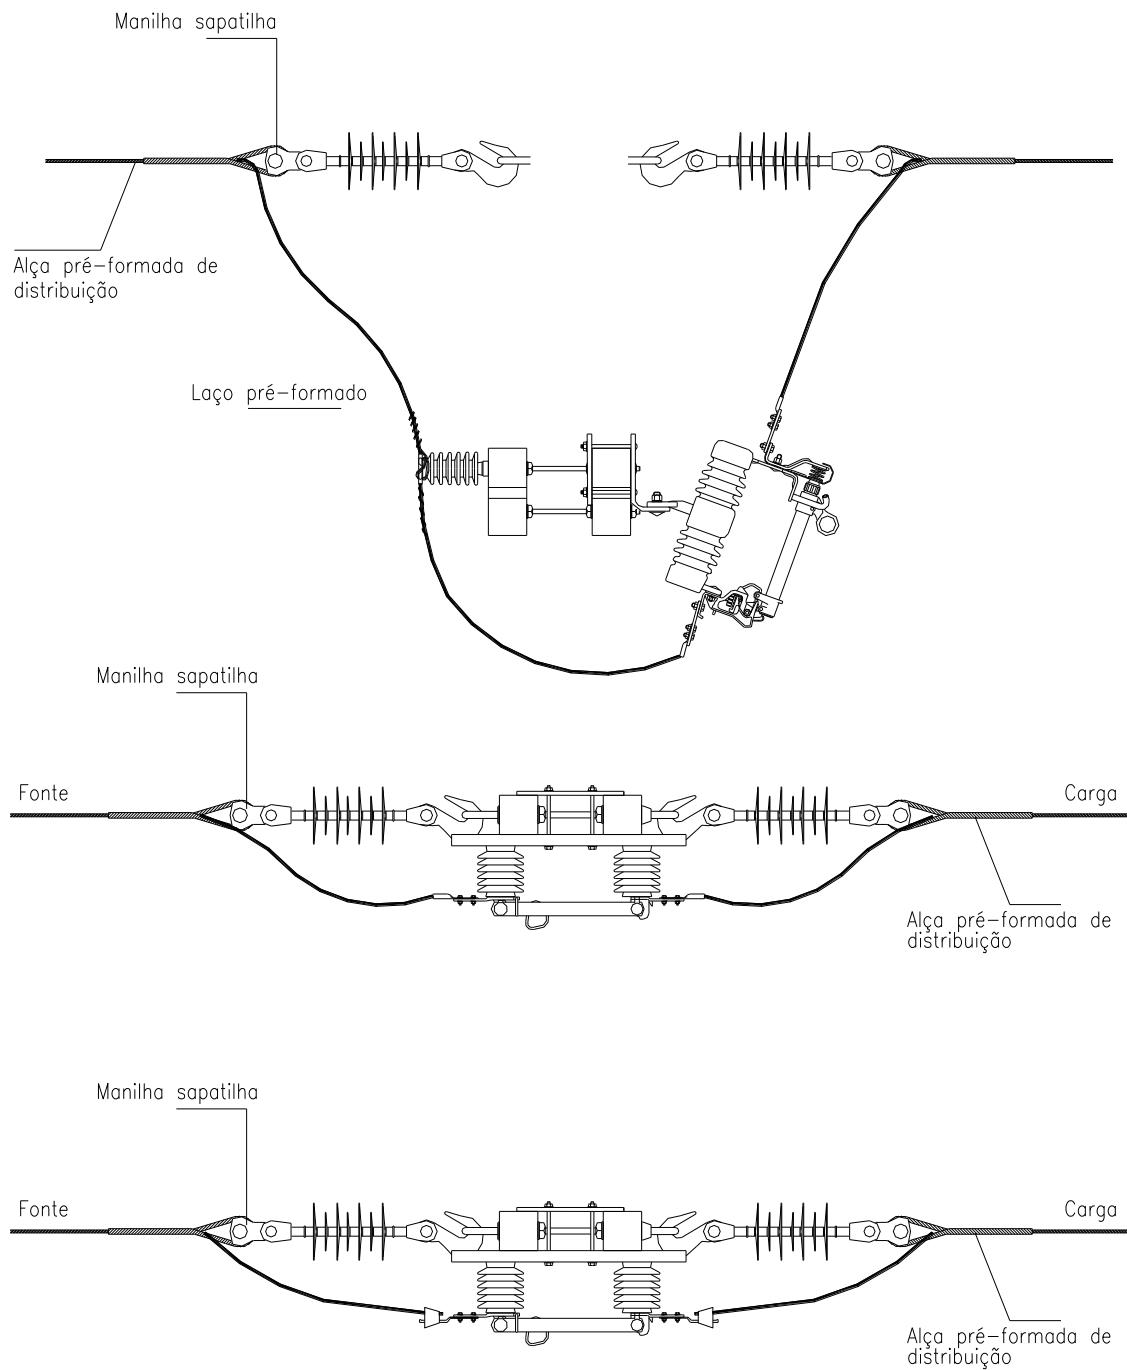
Amarrações e ligações – Primário – Chave-fusível e faca ao longo da rede
